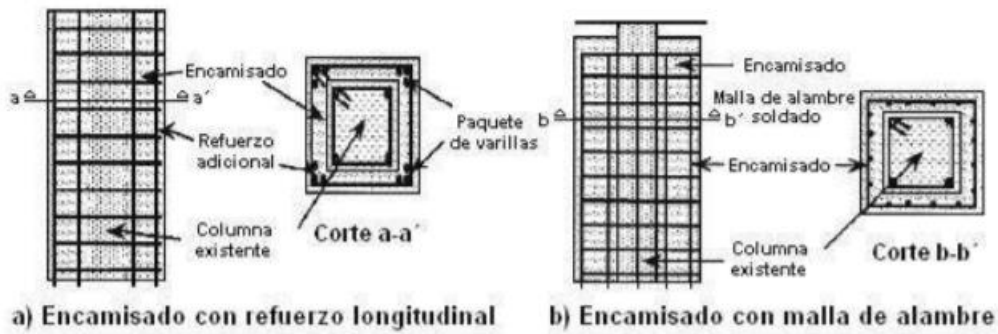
Encamisado de columnas (Belizario, 2017)
